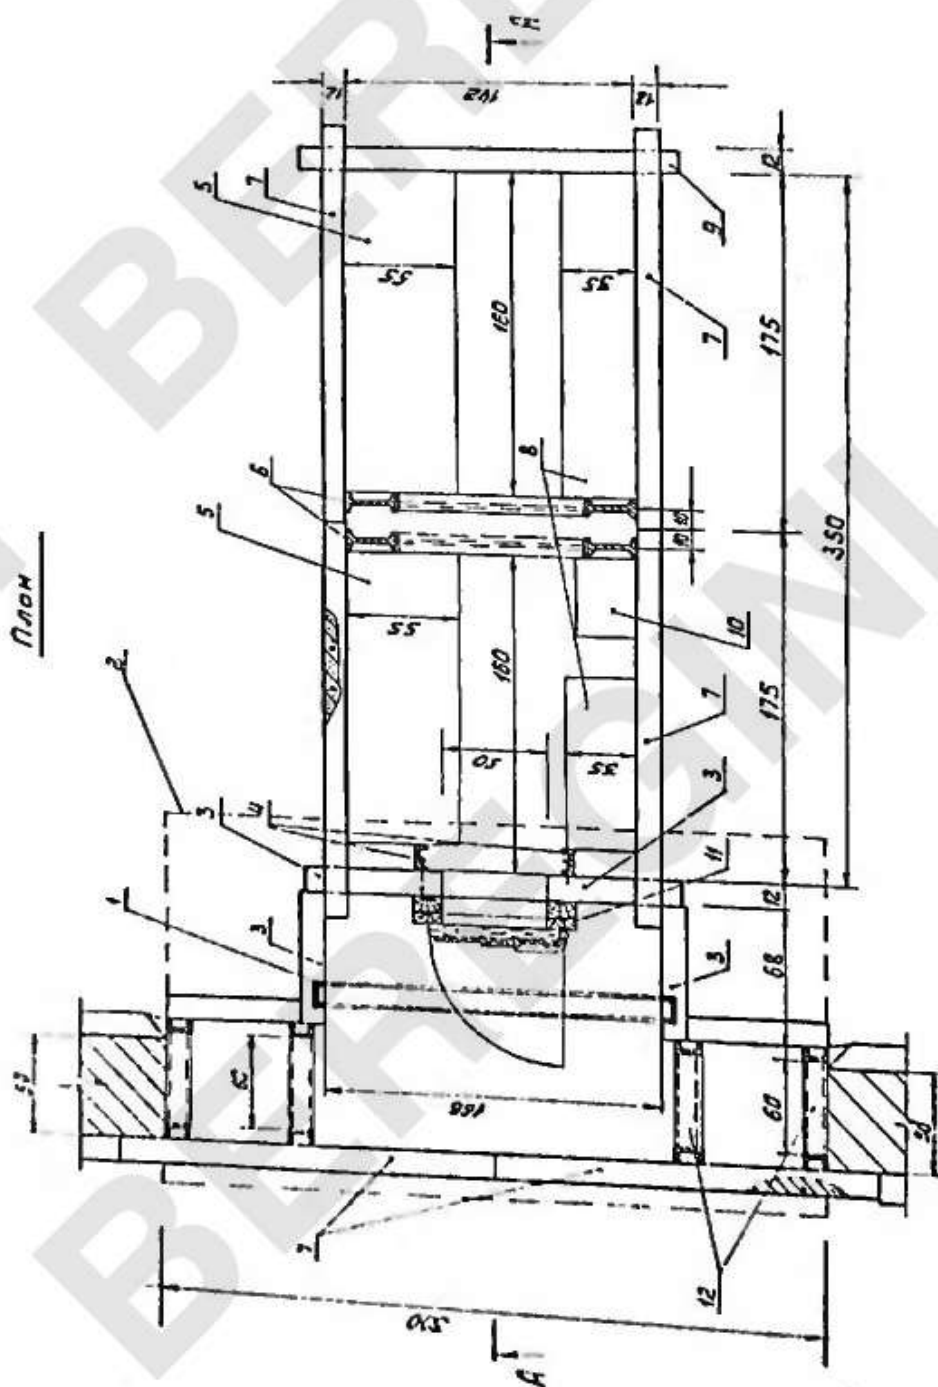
Бліндаж із залізобетонних елементів (план):
